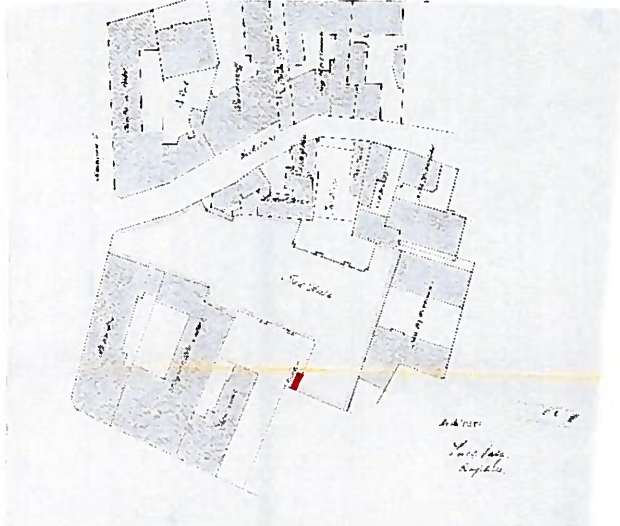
Lageplan 1898 mit allen Grundstücken, die zum „Etablissement Walhalla“ gehörten, Bauakte Stadt Wiesbaden
